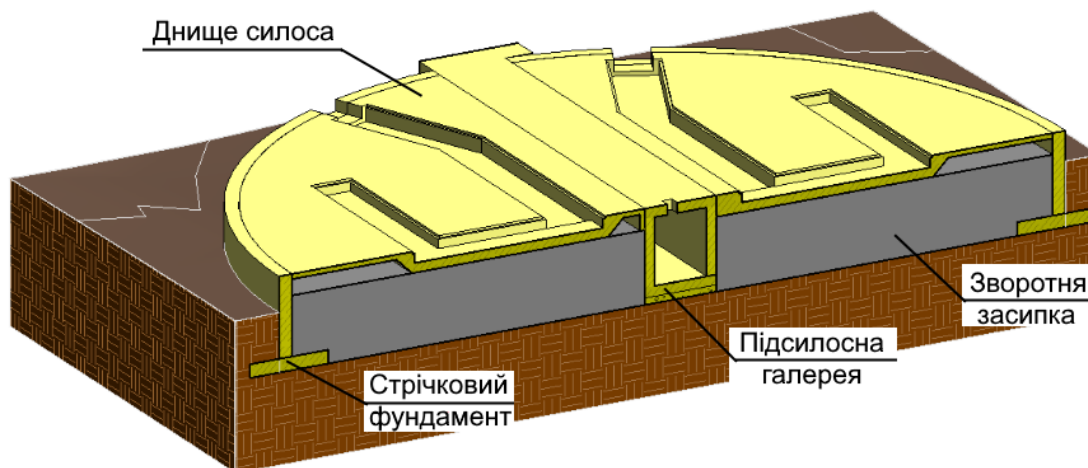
Модель фундаменту (окрема фундаментна стрічка під стінками силосу, підземна галерея та днище) силосу
